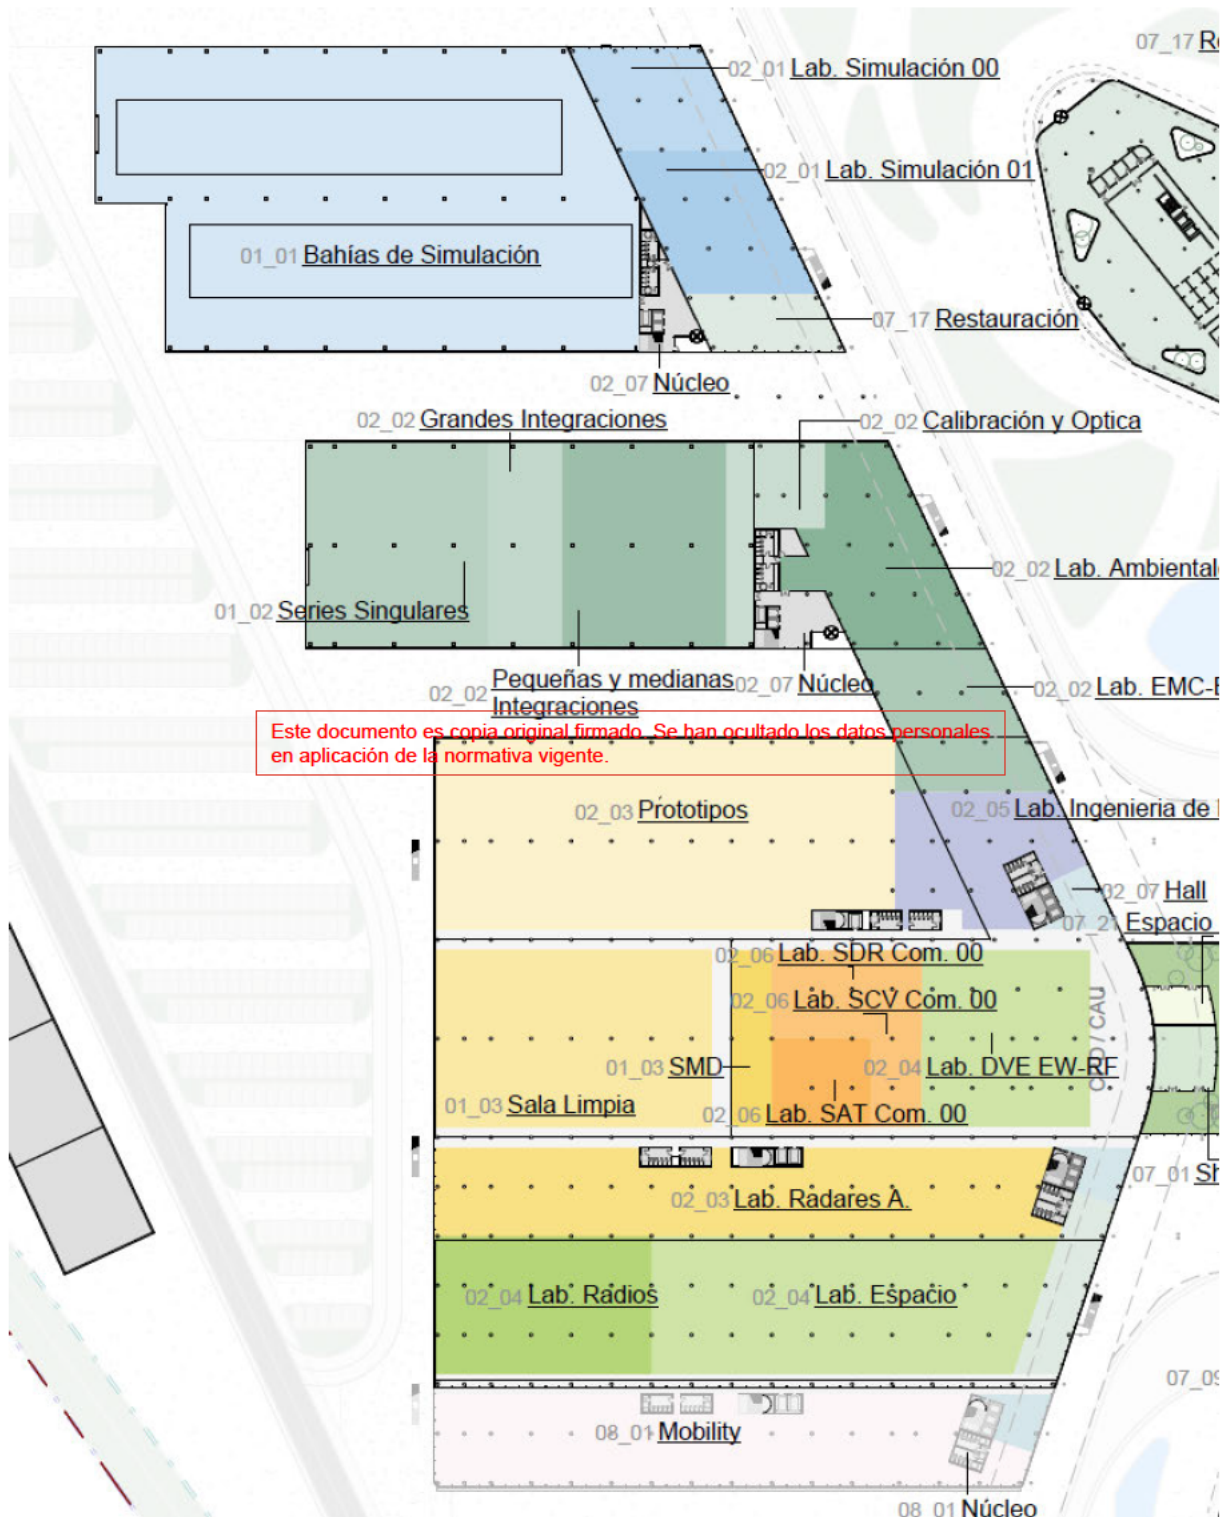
actividades de los edificios D1 y D2 en planta baja. Fuente: Ortiz León.
